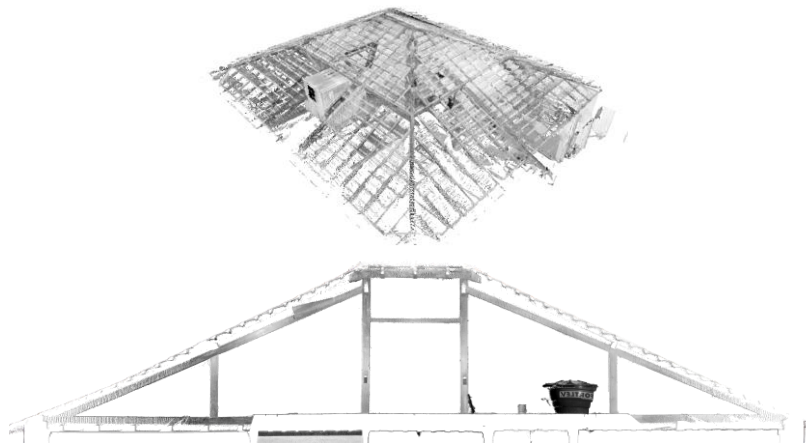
Vista 3D (esq.) e corte transversal (dir.) de estrutura de telhado.
